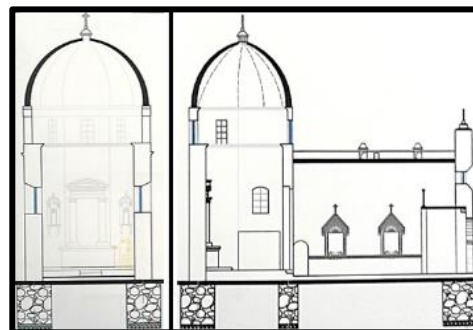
Cortes de la Parroquia de Santa María de las Rosas. (Esquivel, 2016)
